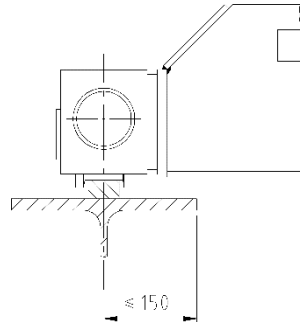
Muestra de apoyo de una de las ruedas del puente grúa en la viga carrilera
